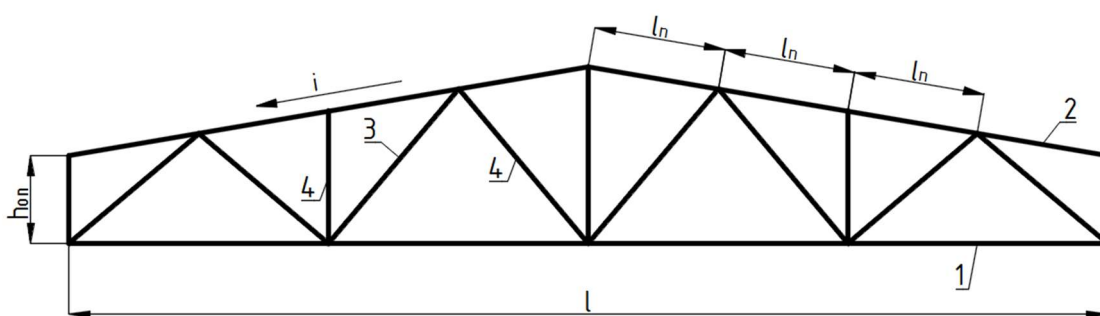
Ферма: 1- нижний пояс; 2- верхний пояс; 3-раскосы; 4- стойки.
